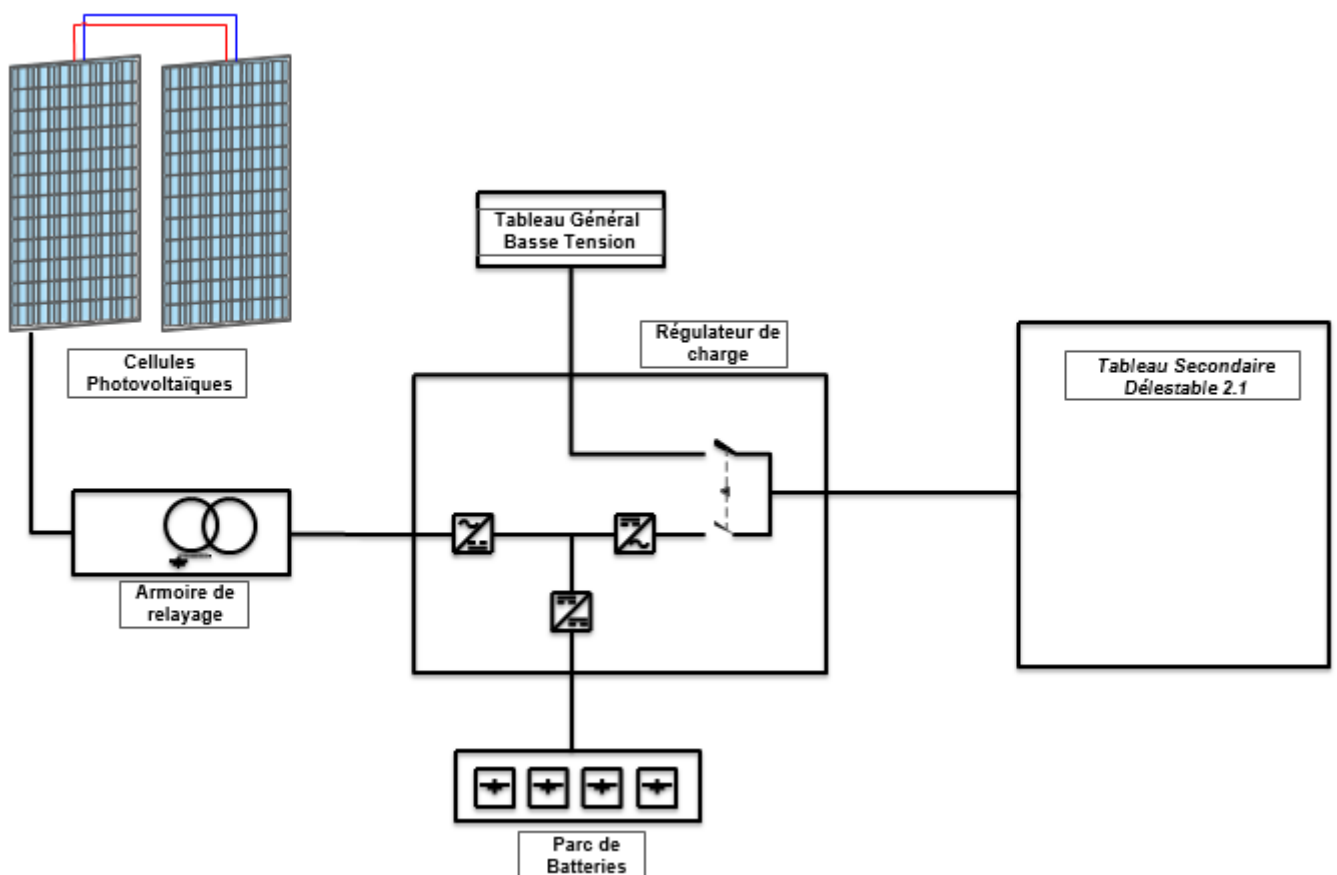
Schéma de principe d'une installation de dalles Wattway avec parc de batteries
